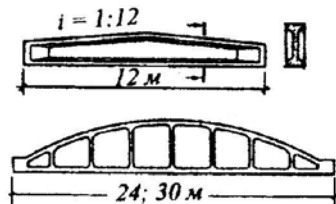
Збірні залізобетонні балки (а) і ферми (б) покриття для громадських будівель
